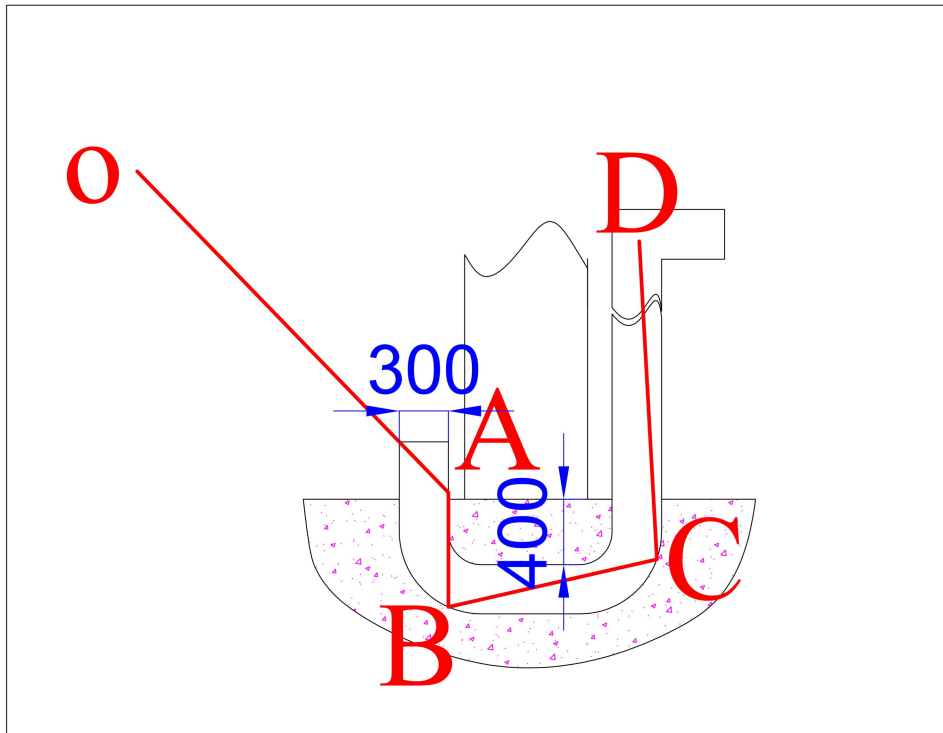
本项目探伤房曝光室通风管道散射示意图（单位：mm）
